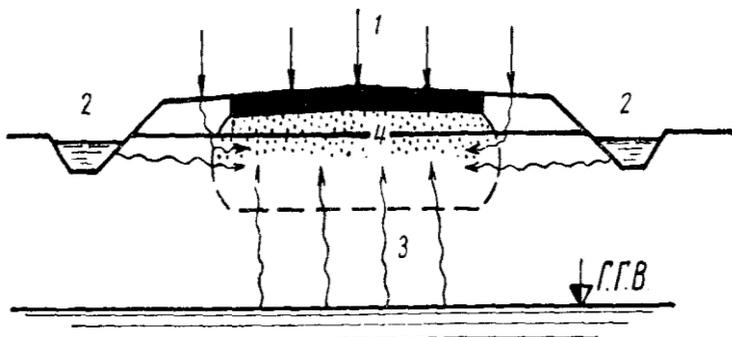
Источники увлажнения грунтов земляного полотна: 1 – атмосферные осадки; 2 – застаивающаяся в кюветах вода; 3 – грунтовые воды; 4 – капиллярная вода
